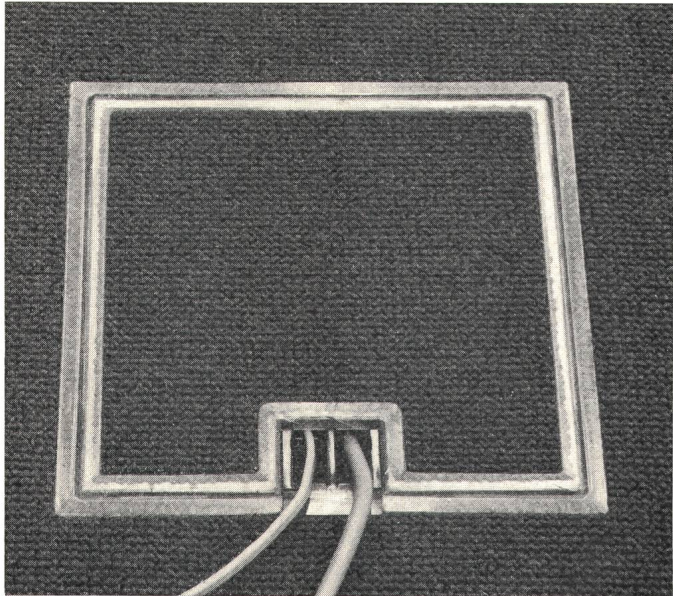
Bodenkasten mit geschlossenem Deckel und Schnurausführungen
